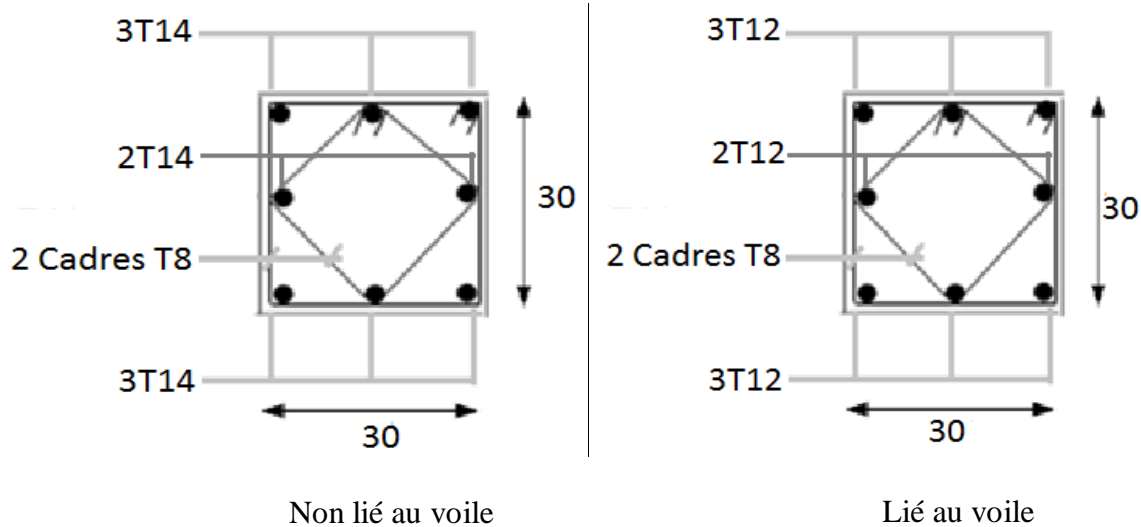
Ferraillage des poteaux de 7^{ème} et de 8^{ème} étage.
